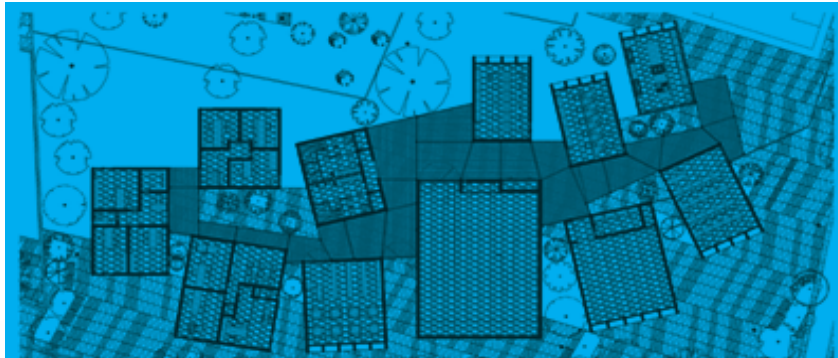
Planta Arquitectónica del Centro Comunitario de Celaya . Fuente: Arch Daily.
